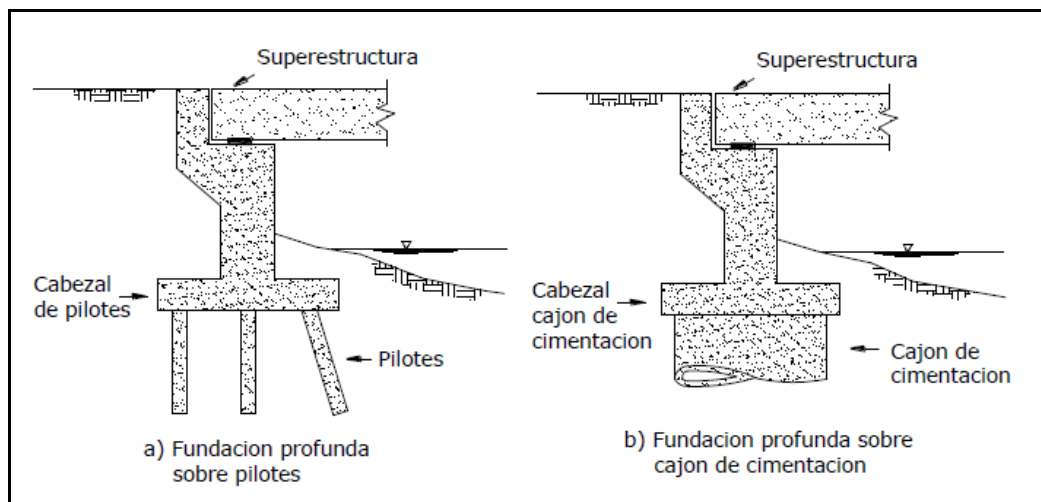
Fundación profunda sobre a) pilotes, b) cajón de cimentación
